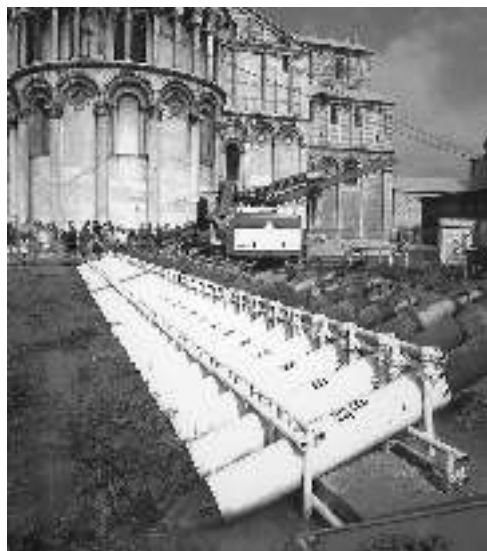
intervento di sottoescavazione: tubi guida per l'estrazione del terreno al di sotto dell'anello di fondazione della Torre.
